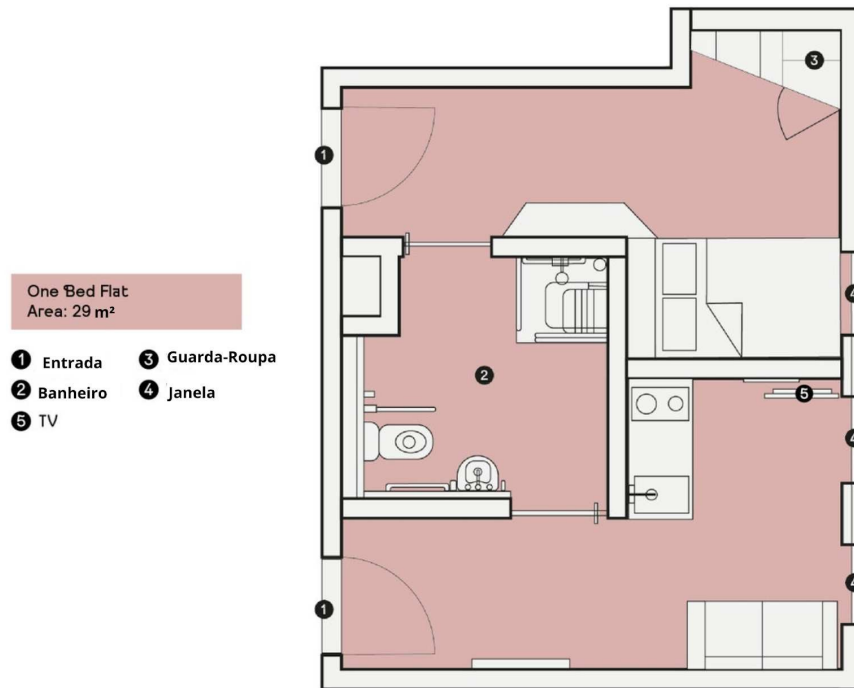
Planta baixa quarto tipo 03-Bed Flat
